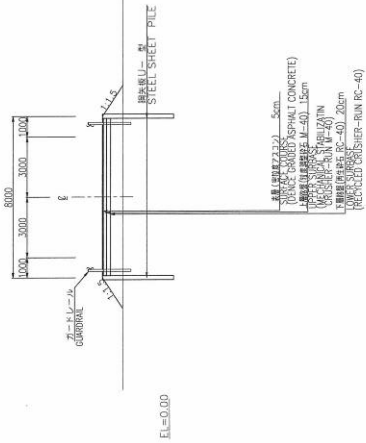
(2) 工事用仮設道路標準断面図 (B区間)
